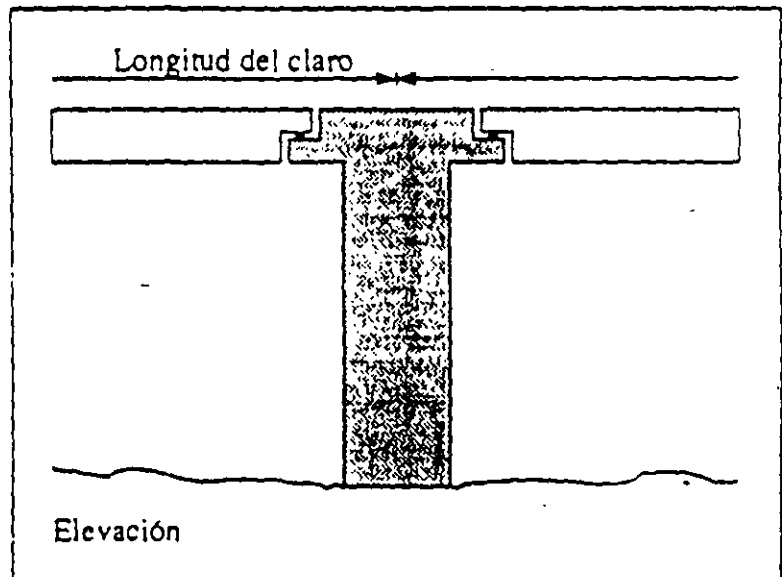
Pila, tipo 31 - 33, columnas con cabezal
